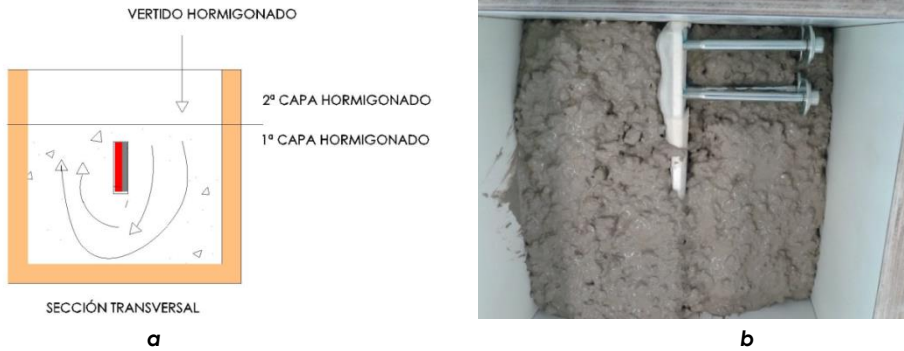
Esquema vertido hormigonado probeta tipo (a) y vertido hormigón (b).
